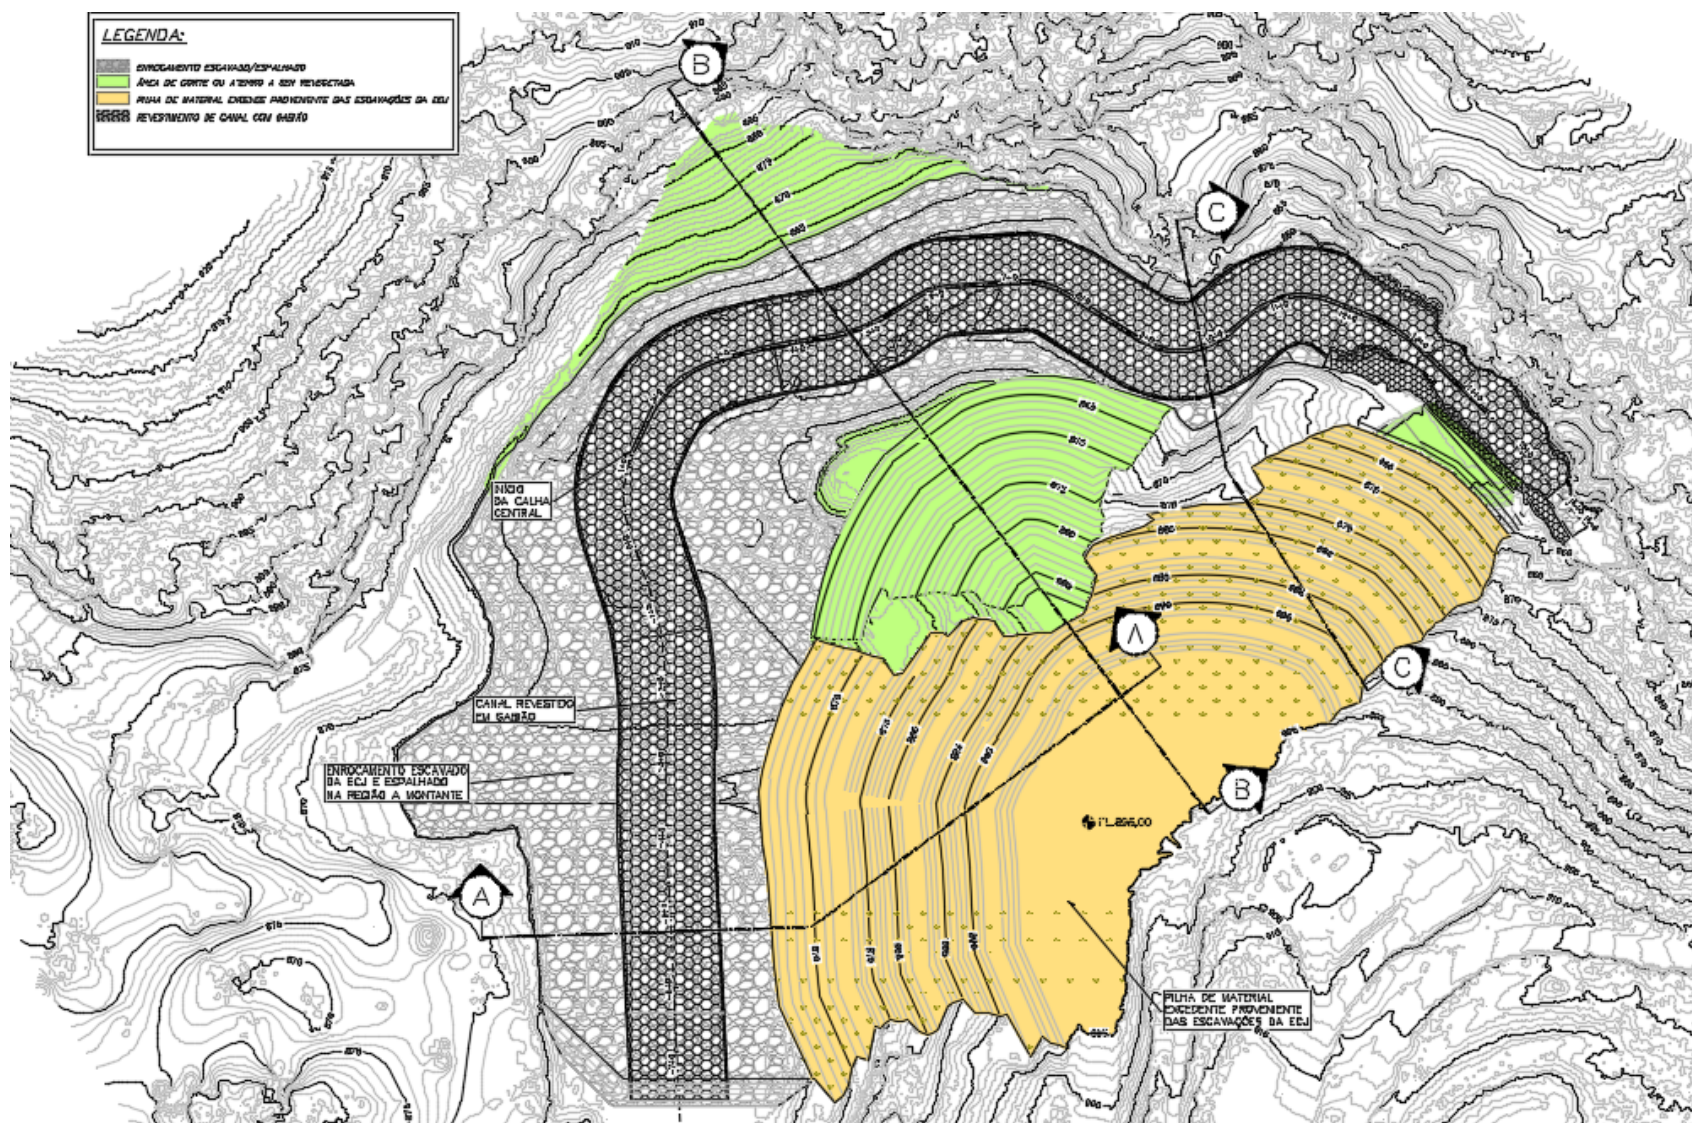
Arranjo Geral – Descaracterização da ECJ.
